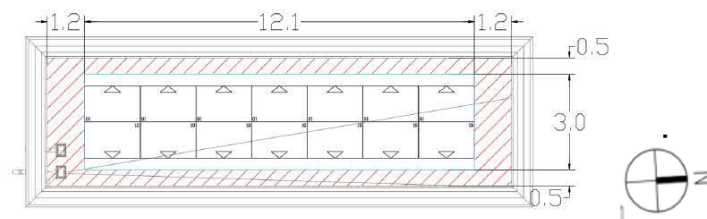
Dachfläche M-1; je Dachfläche ca. 14 Module, je Dachfläche ca. 5,6 kWp, Neigung 10°
